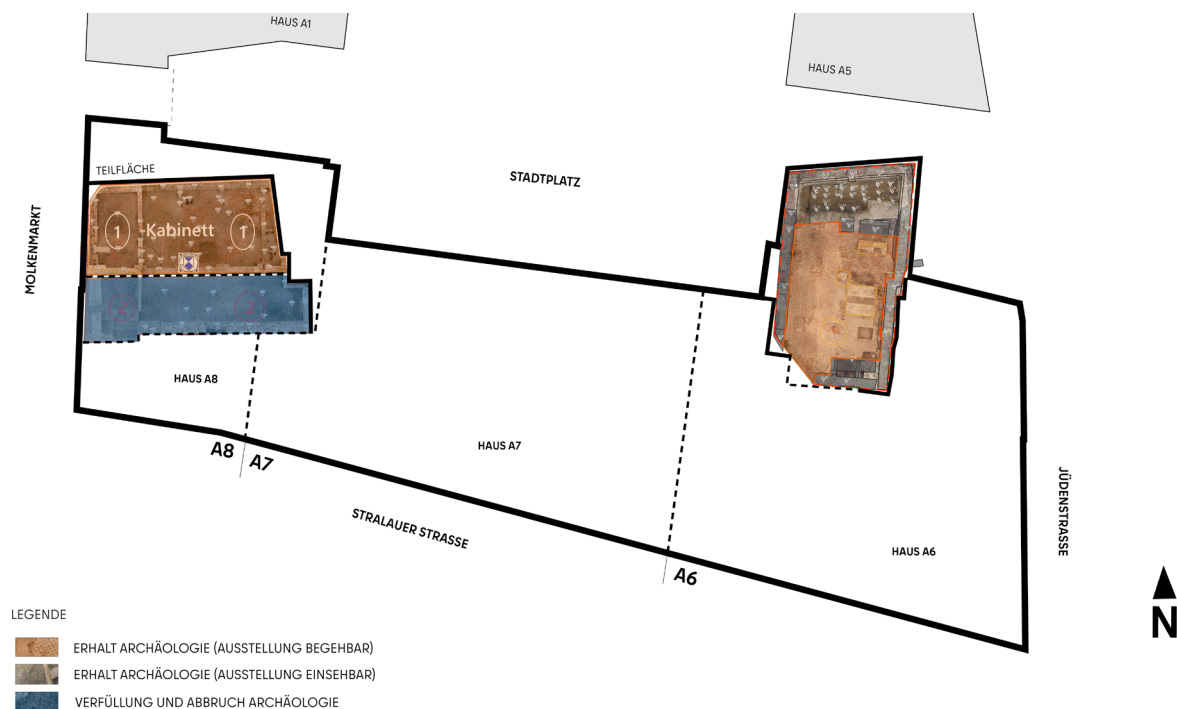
Schematischer Grundriss Untergeschoss
